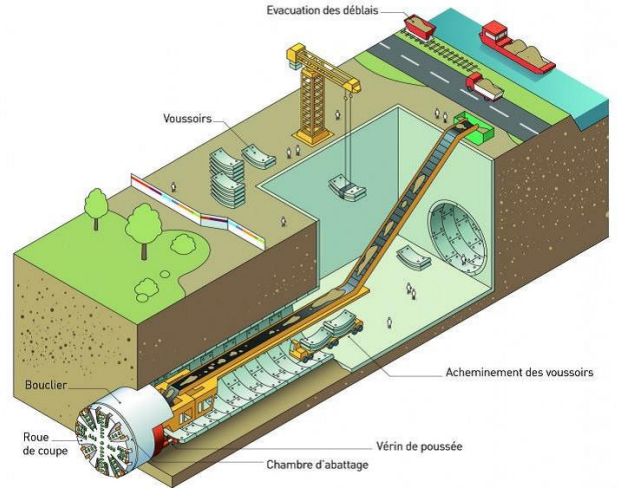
Schéma de fonctionnement d'un puits d'entrée de tunnelier
